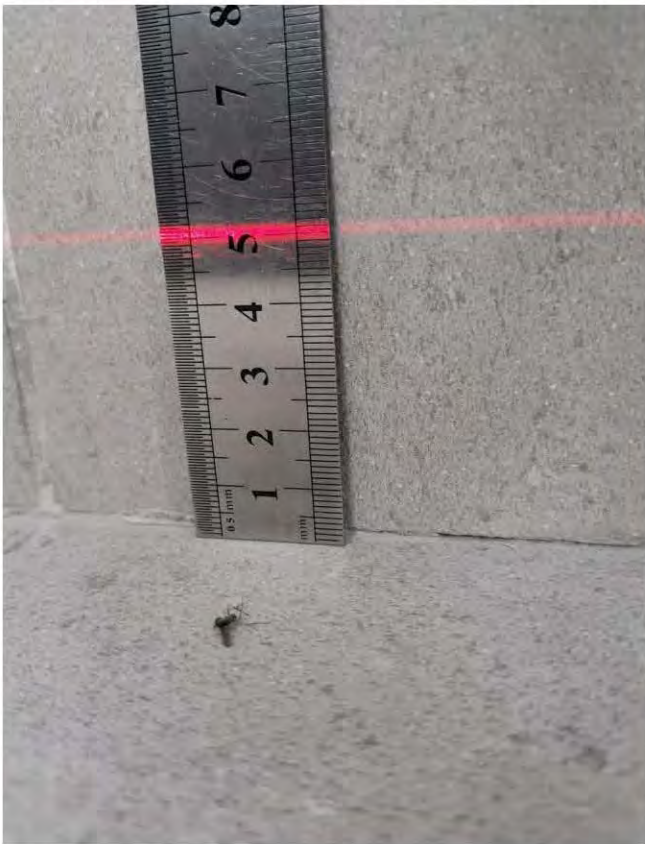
Лоджия (4,0 кв.м.) 8.7 Отклонение напольного покрытия от горизонтального уровня 10 мм на все помещение
